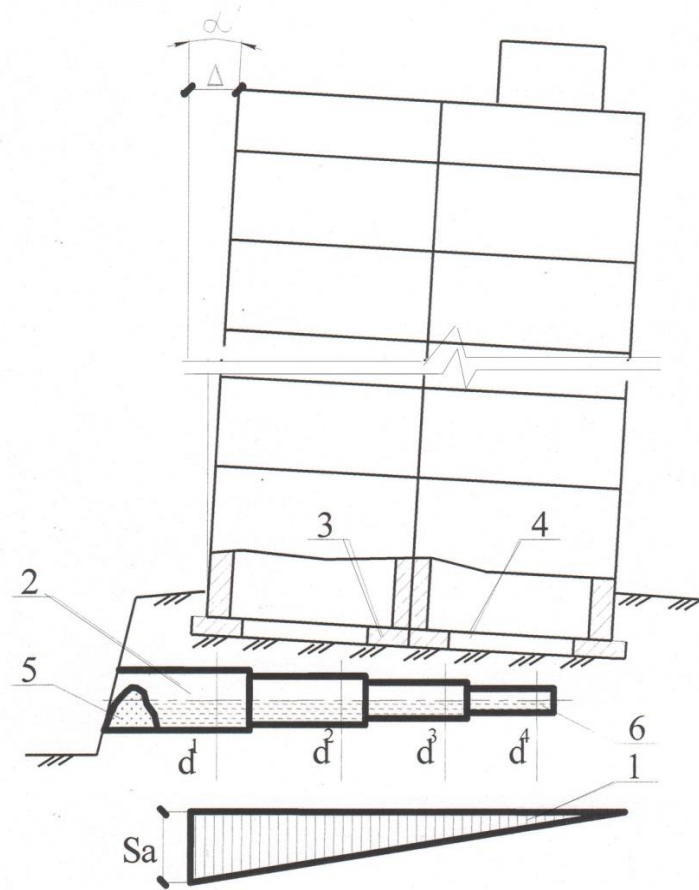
Схема усунення нахилень будівель шляхом вибурування ґрунту основ фундаменту:
